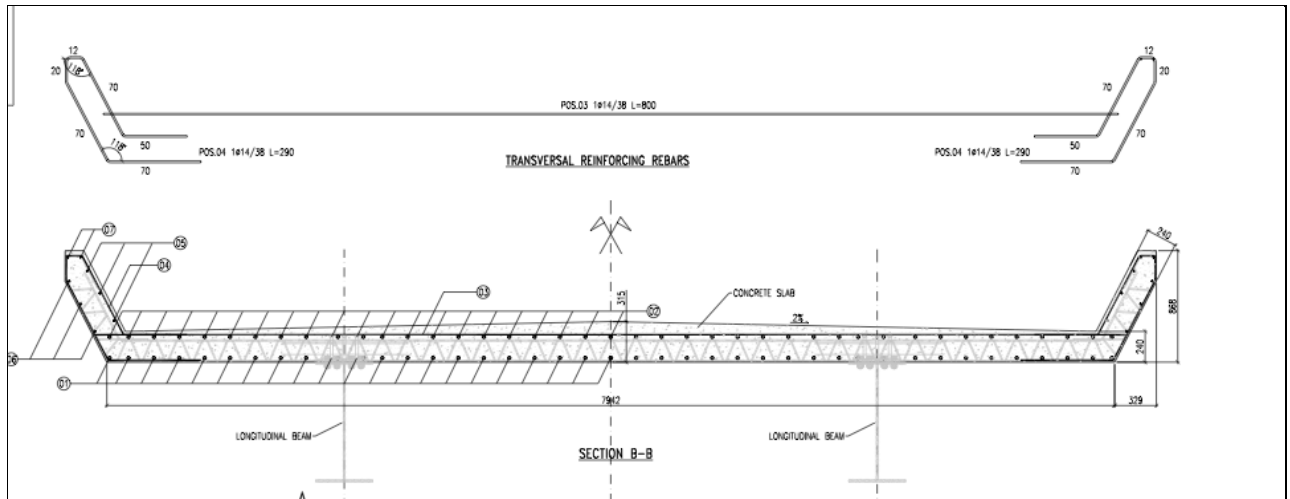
Exemplu de tablier cu cuvă din beton cu esafodaj metalic pierdut
